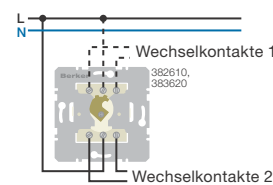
Wechselschalter 1- und 2-polig für Schließzylinder [Best.-Nr. 3826 10, 3836 20]
